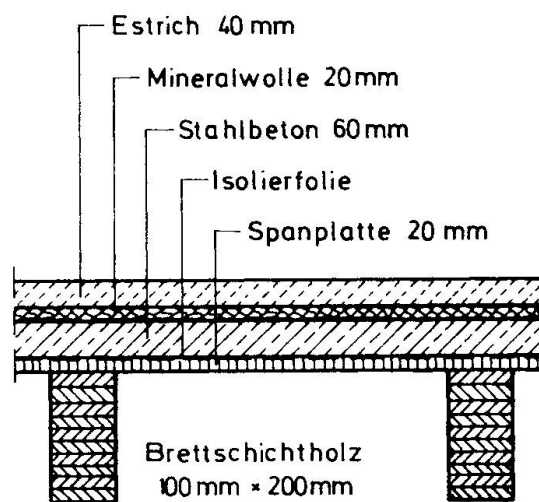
Querschnitt einer Holzbalken-Verbunddecke (nach [2])
